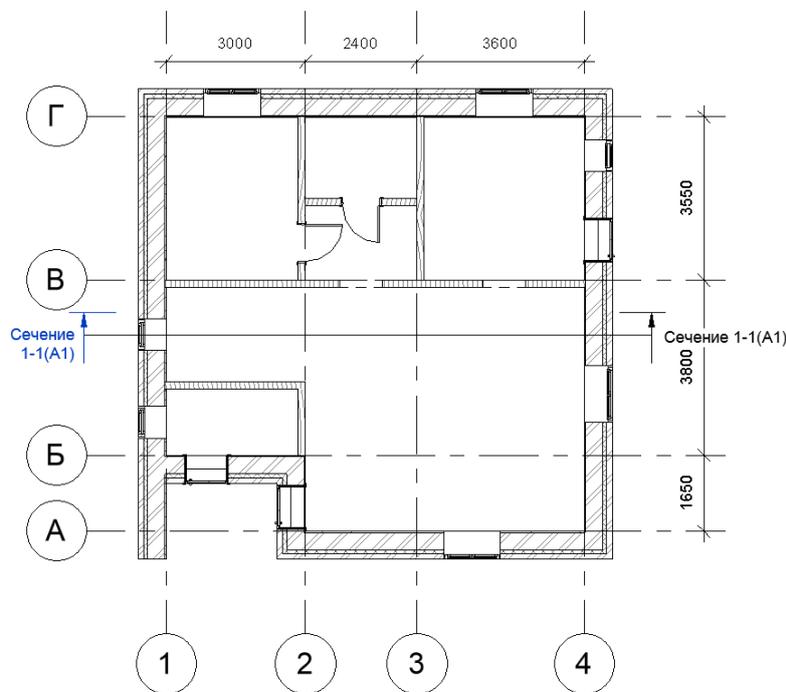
Вставка окон и дверей на плане 1-го этажа
